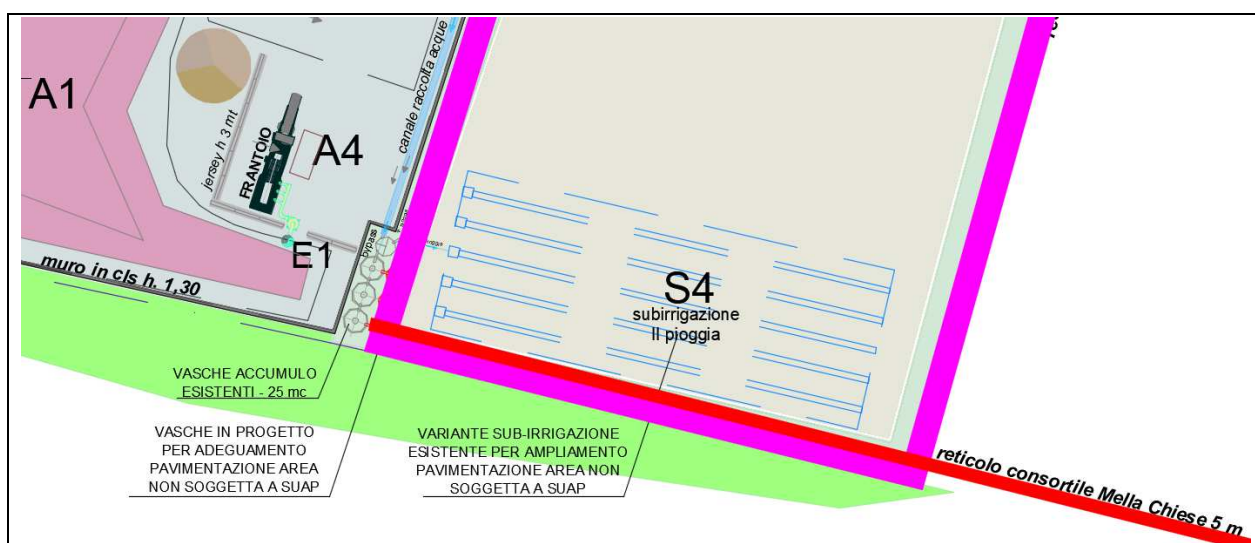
Dettaglio planimetria indicante il limite della fascia di rispetto di 5 m dal Vaso Saugo
